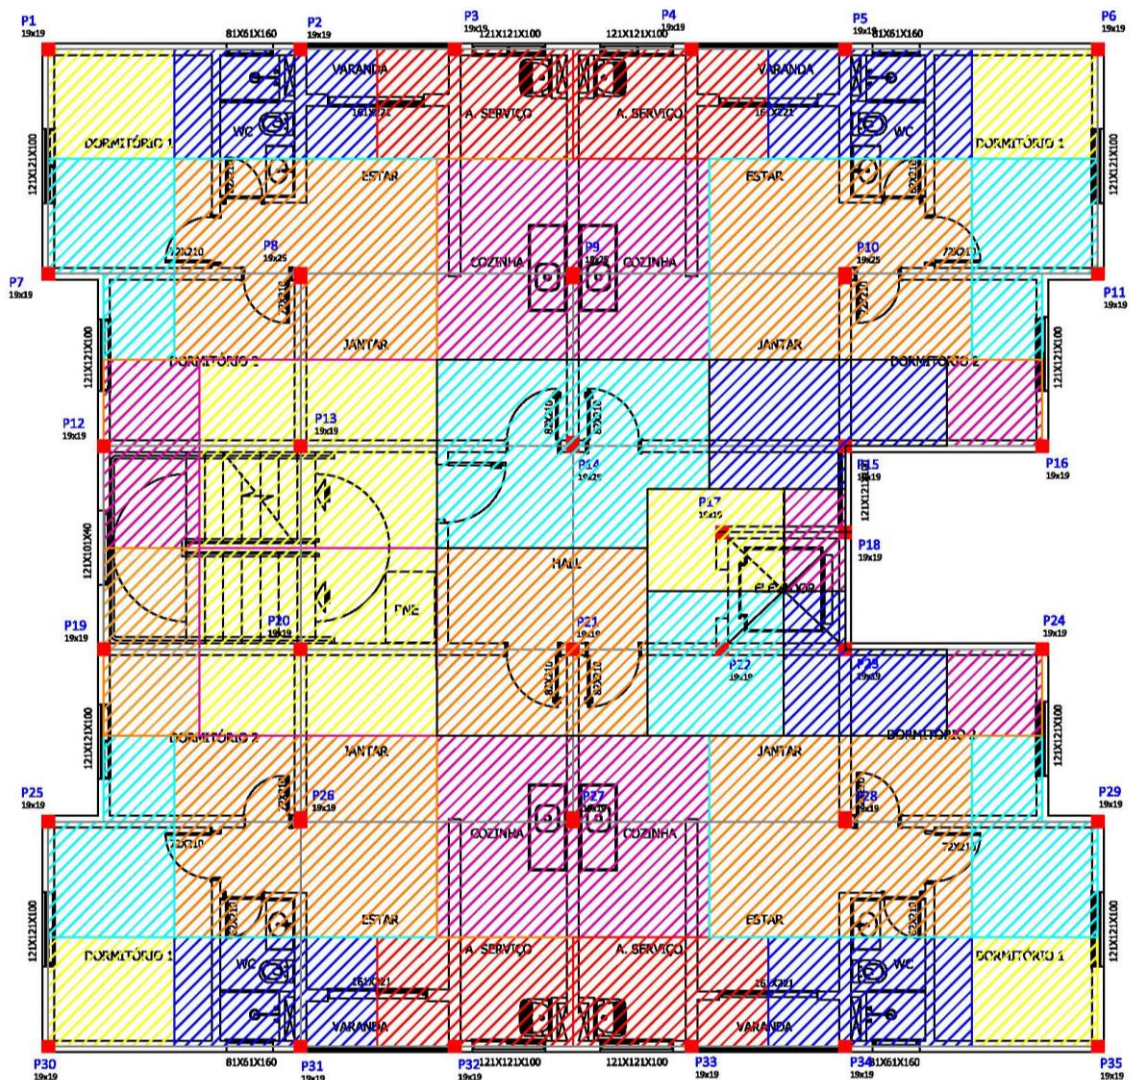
Área de influência dos pilares da primeira concepção estrutural (Fonte: autor próprio)
